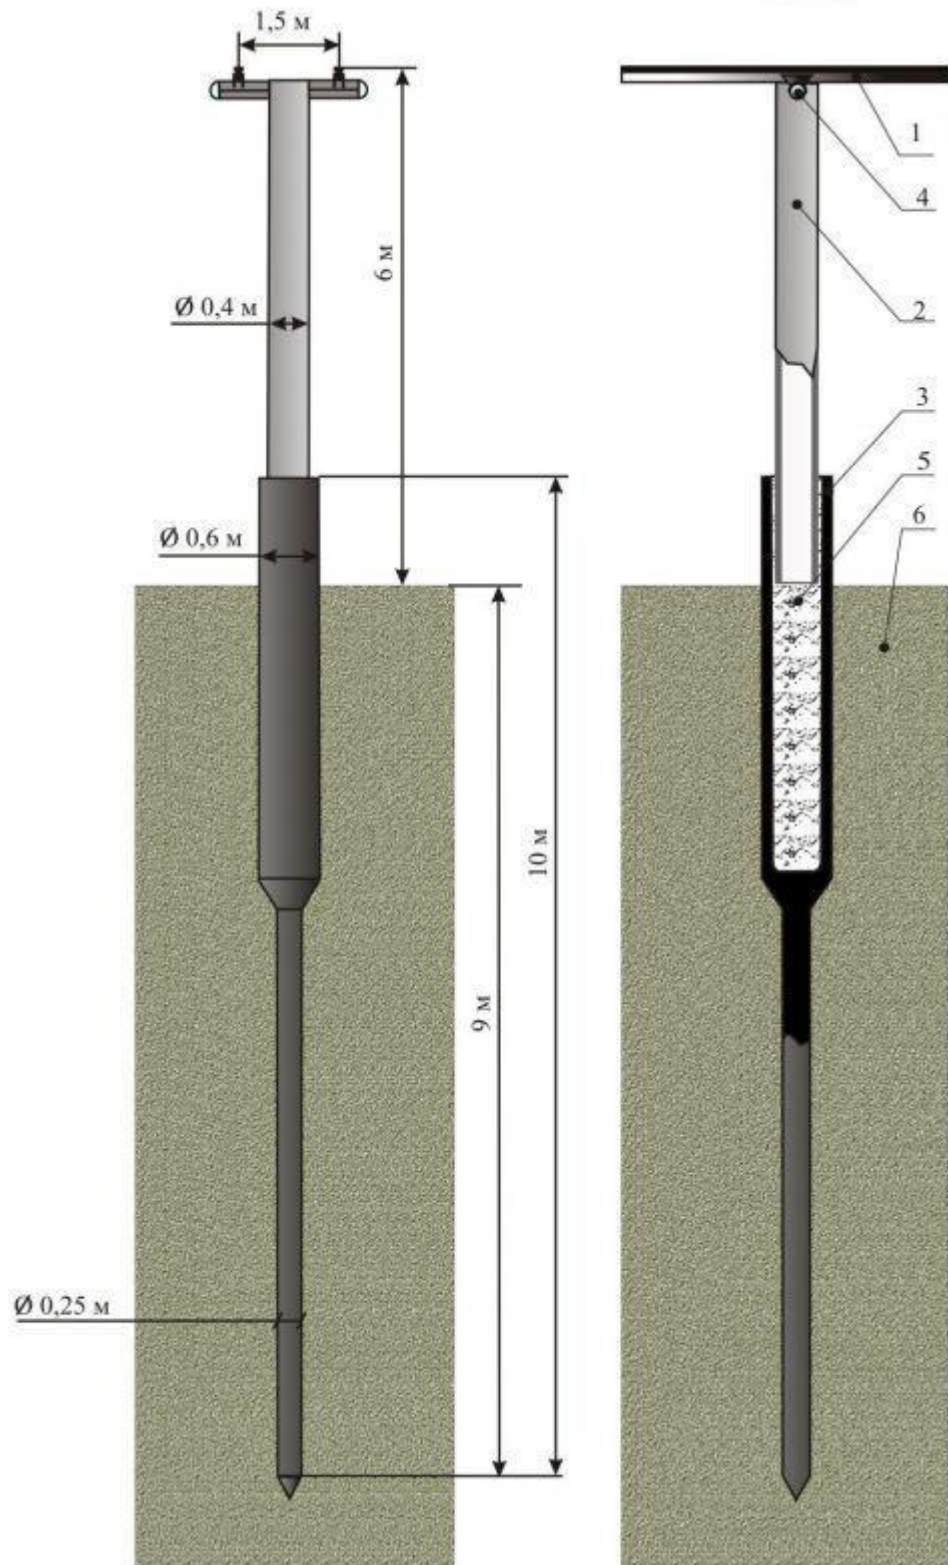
Поддерживающая железобетонная опора однопутной трассы СТЮ колеей 1,5 м на свайном фундаменте: 1 – рельс-струна; 2 – опора; 3 – свая; 4 – фонарь освещения; 5 – наполнитель компенсатора высоты; 6 – земля.
